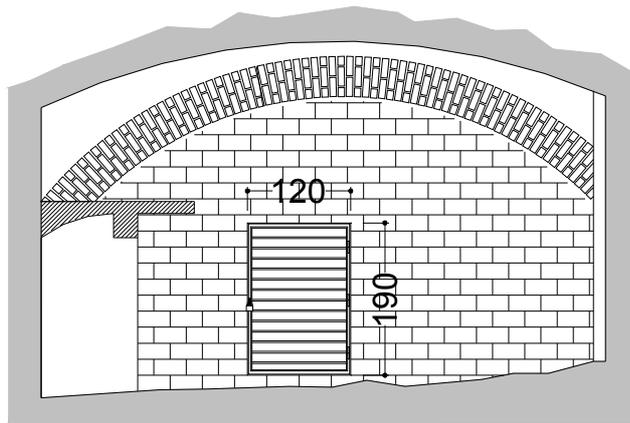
Prospetto dell'ingresso della miniera con l'apertura e la grata in progetto.
